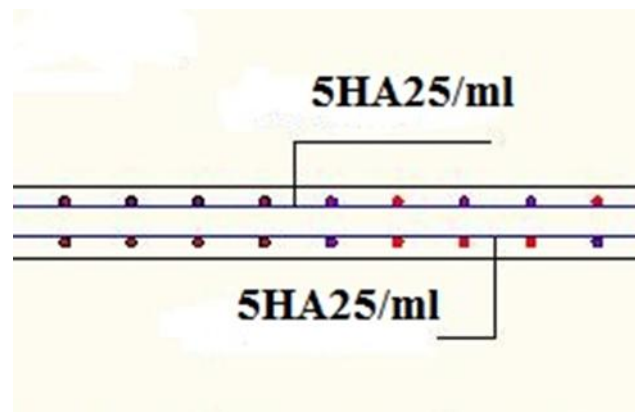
Schéma de ferrailage de la dalle de radier (sens x-x) et (sens y-y).
